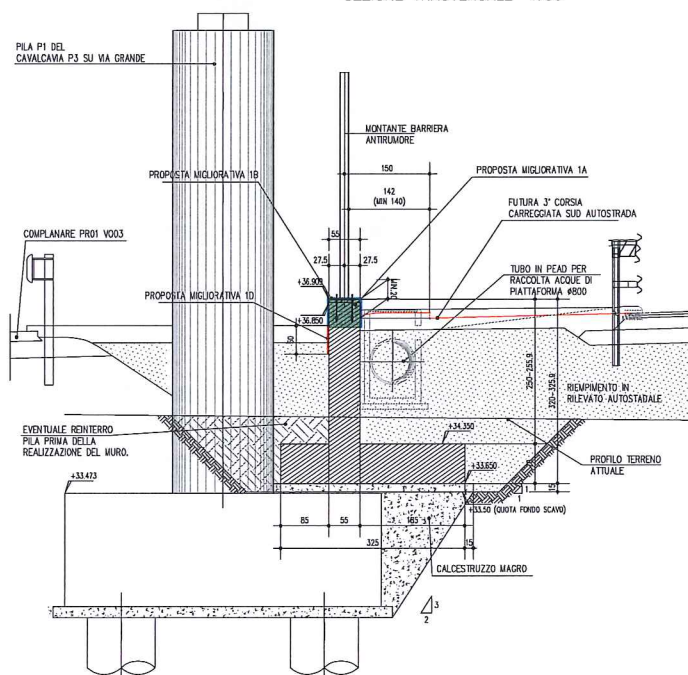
Sezione Tipo – Muro tipo 1 –Conci 1-5
